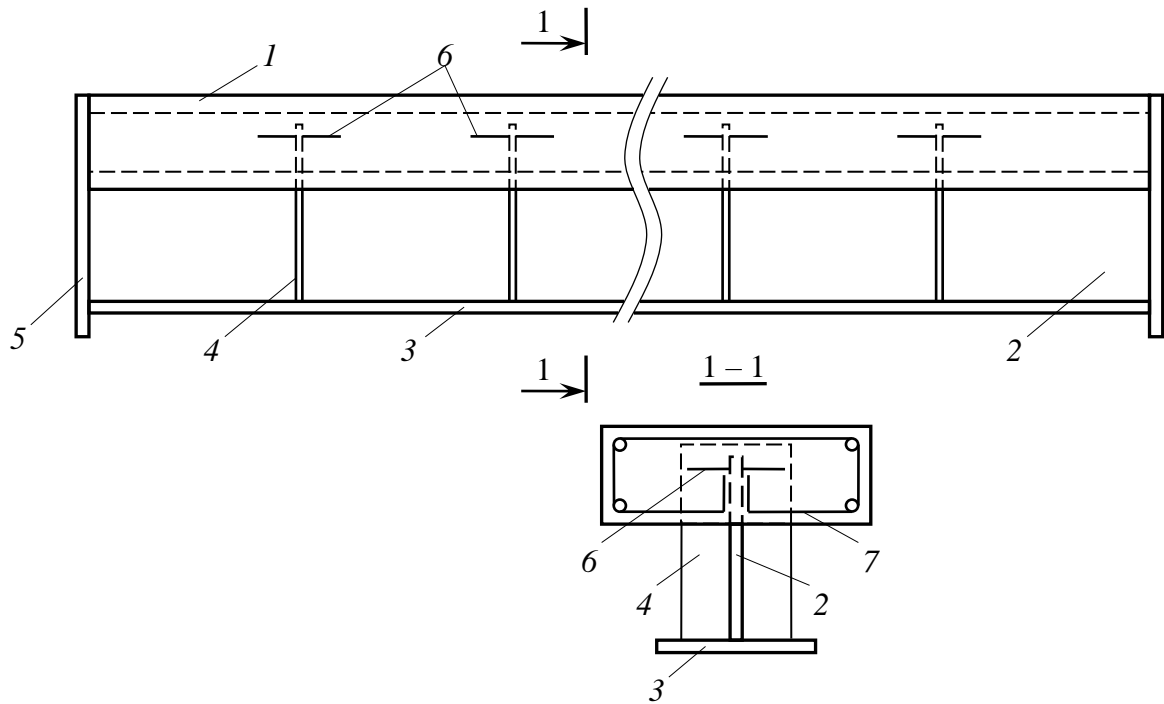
Комбінована залізобетонна балка двотаврового перерізу
